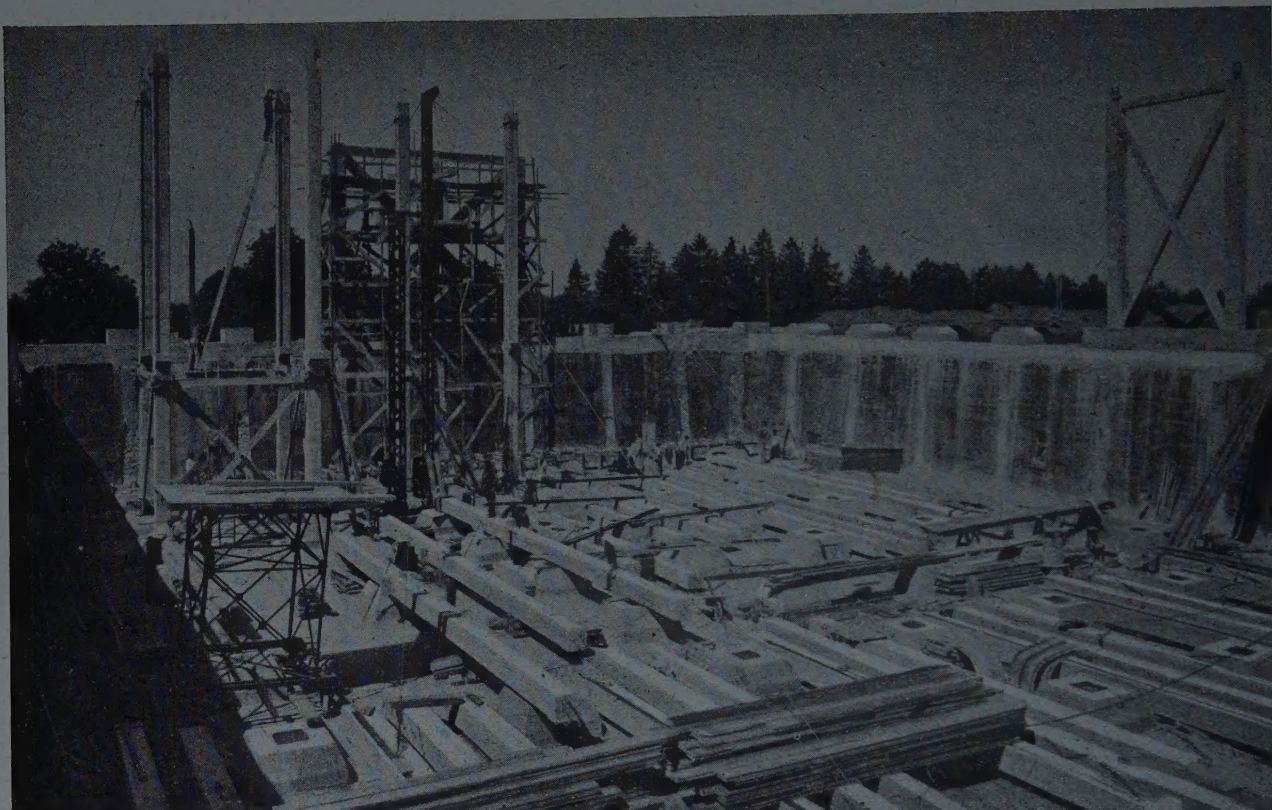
Semelles de fondations. Piliers bétonnés sur le radier de l'ancien réservoir.
